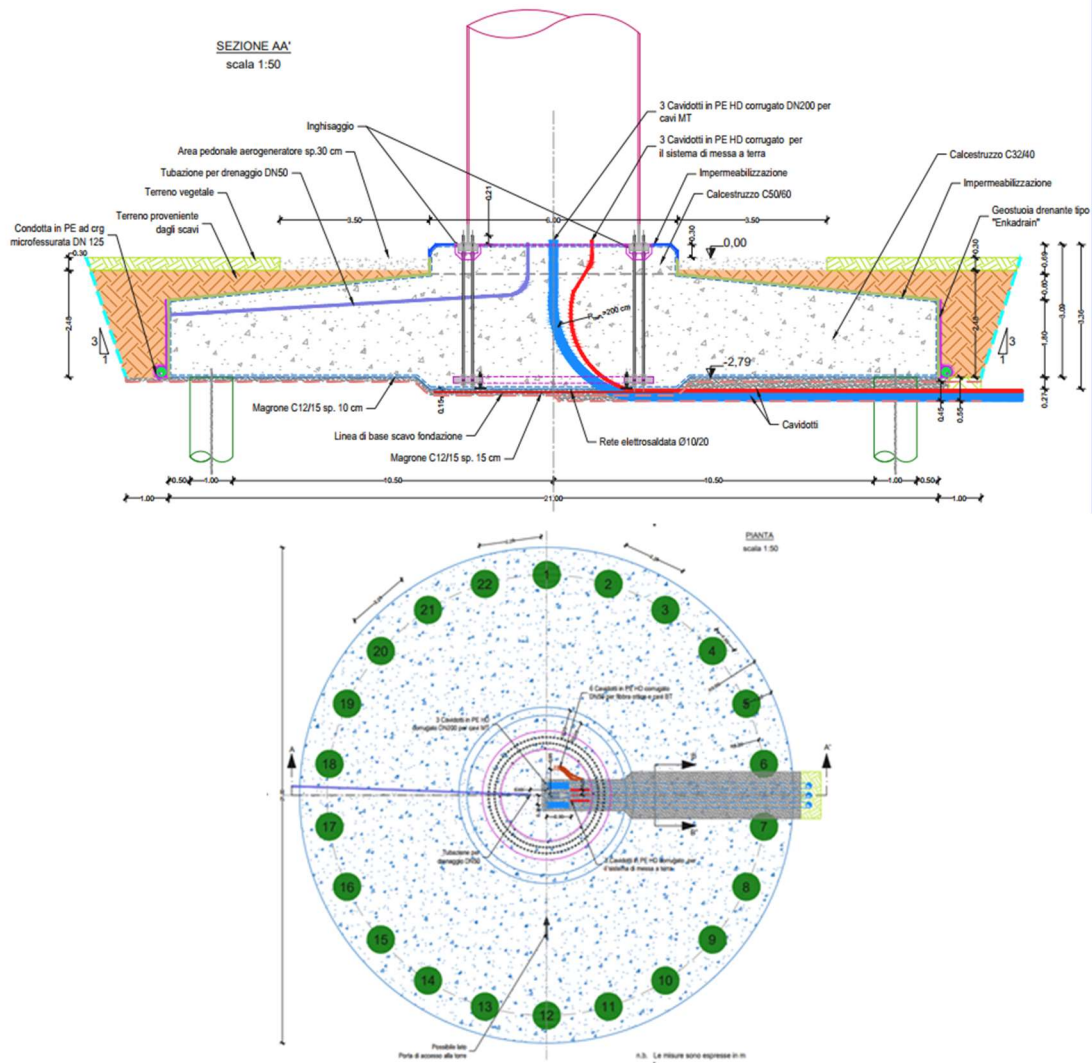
Tipologia della fondazione su pali prevista -diametro fondazione 20,00 m
